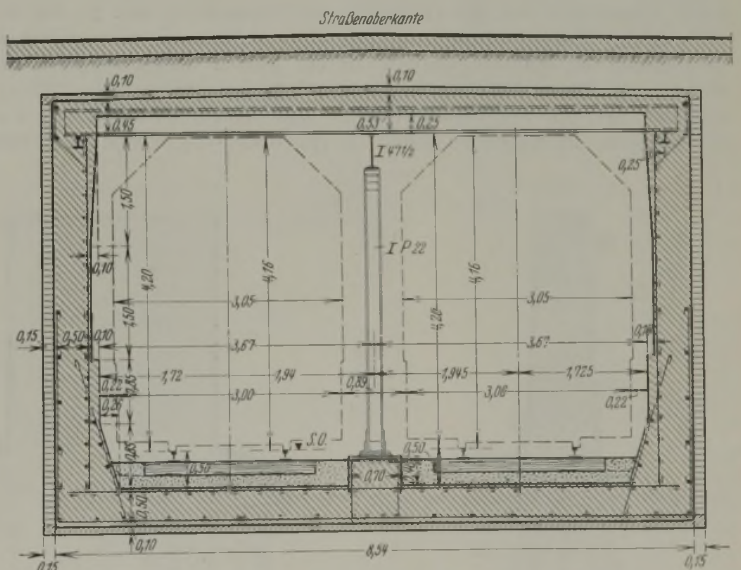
Regelquerschnitt des geschlossenen Tunnels.
